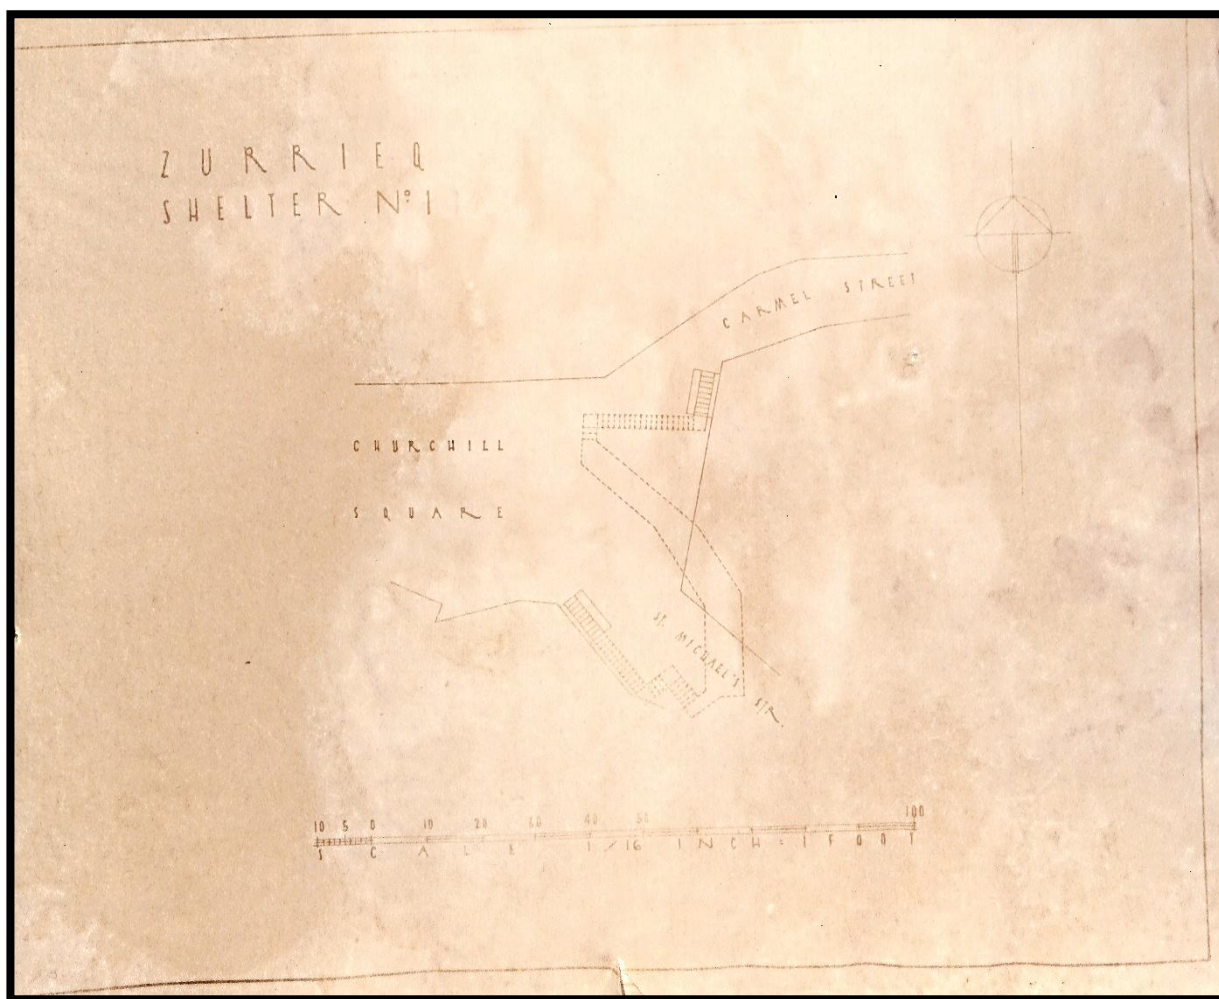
Planta do Abrigo nº1 "Church Square – Carmel Street – St. Michael Street."
